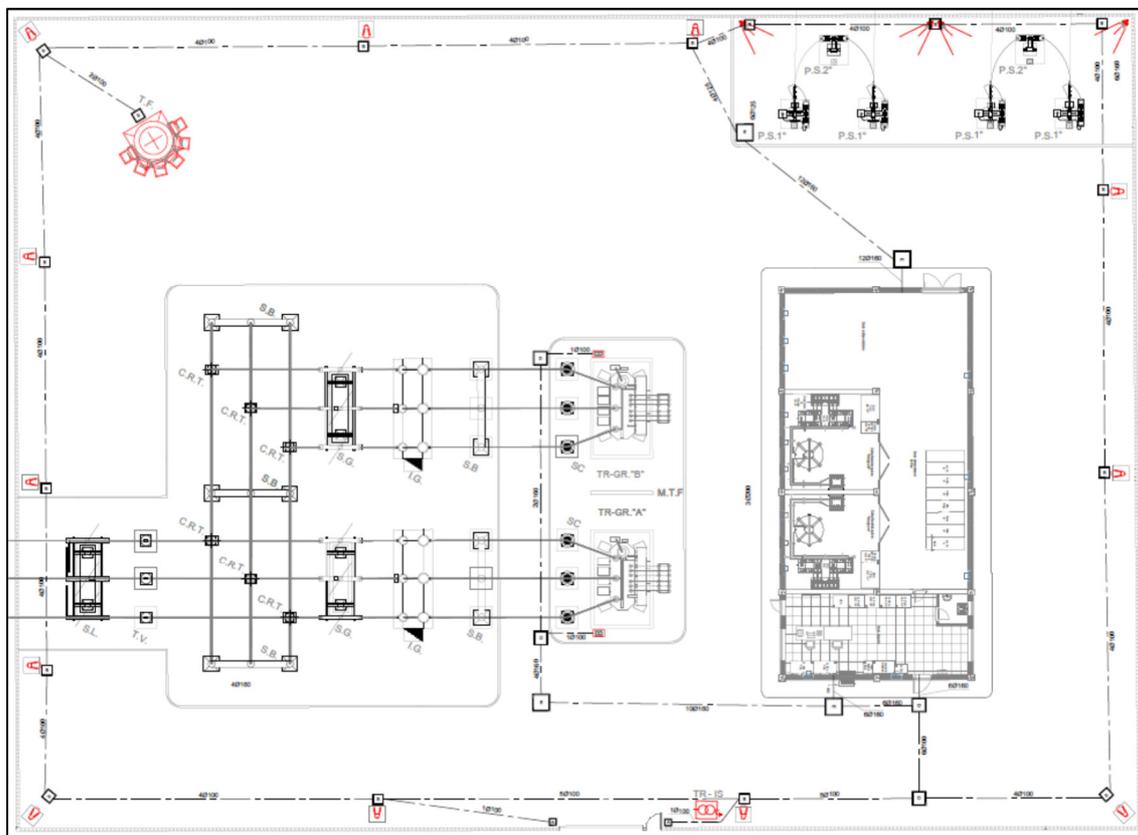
Planimetria impianto luce e forza motrice del piazzale
